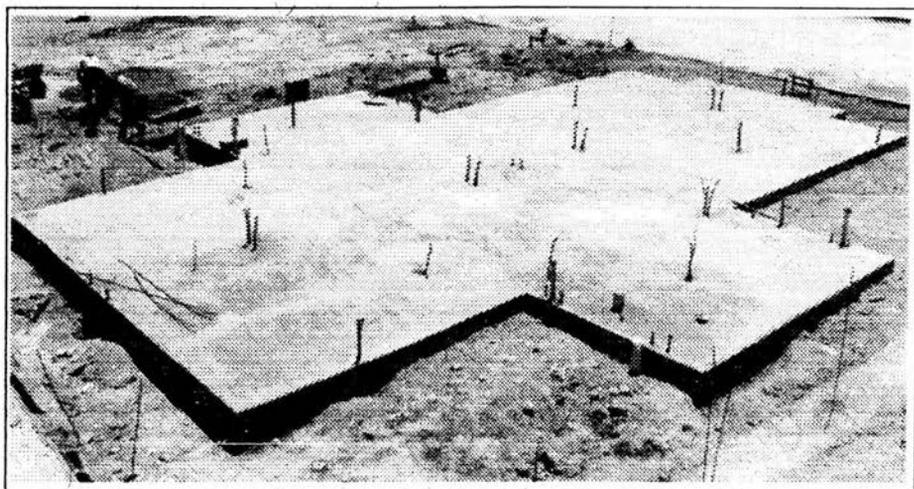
En la figura se observan las salidas de instalaciones que se encuentran embebidas en el firme de concreto reforzado, las salidas deben especificarse en planos.
